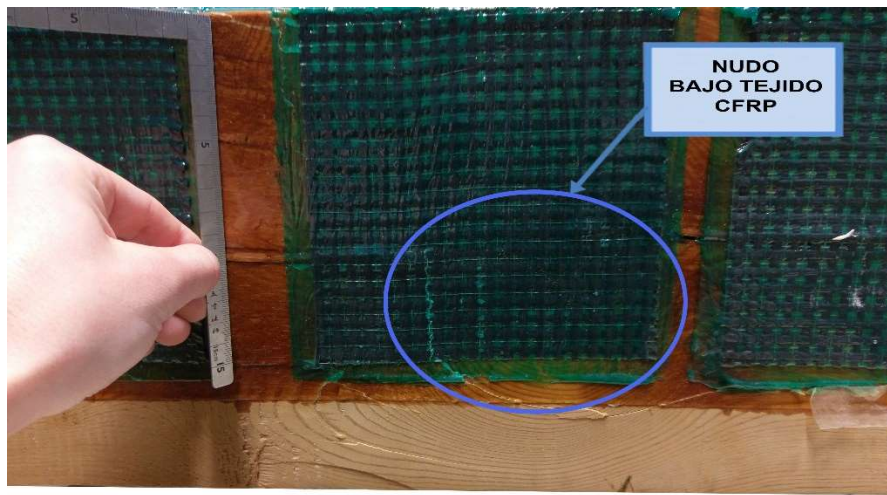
Aparición de nuevas grietas en la viga BR-r-3.
